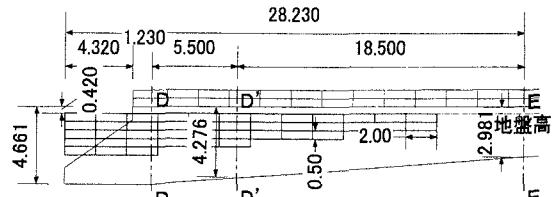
施工 EPS 縦断図 池下側擁壁 (単位 m)
